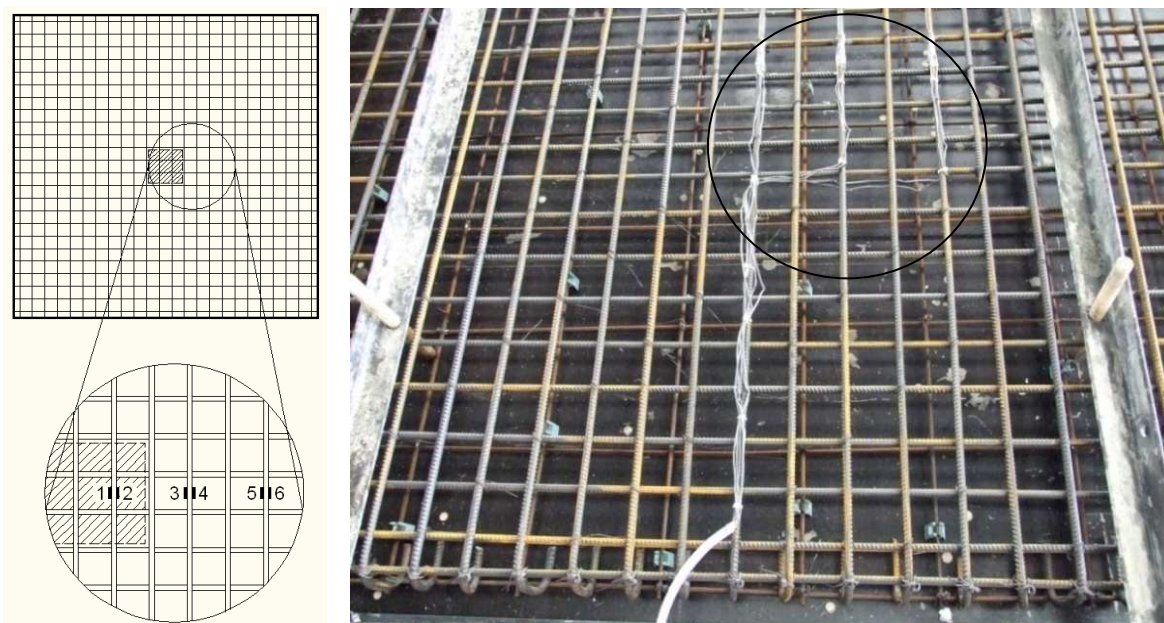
Armaduras instrumentadas antes da betonagem
